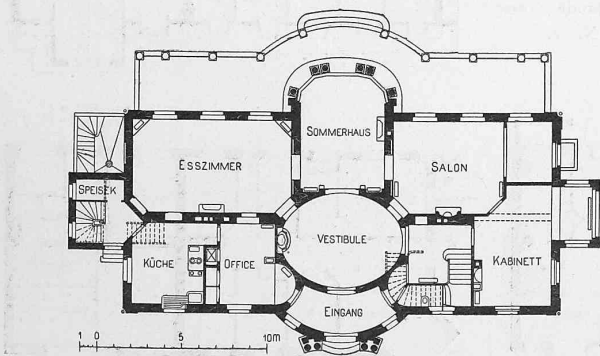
und 12. Grundrisse des Erdgeschosses und ersten Stockes. — Masstab 1 : 400.
